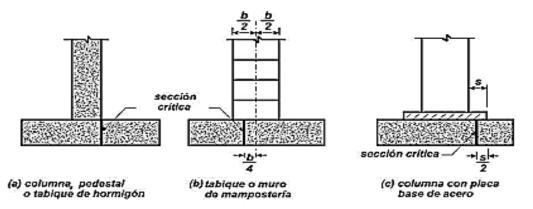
Ubicación de las secciones críticas para momento máximo mayorado en zapatas y cabezales
